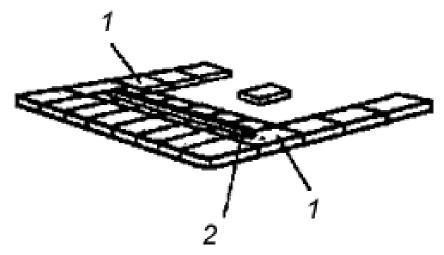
Раскладка утеплителя, где 1 и 2 разные слои теплоизоляции
